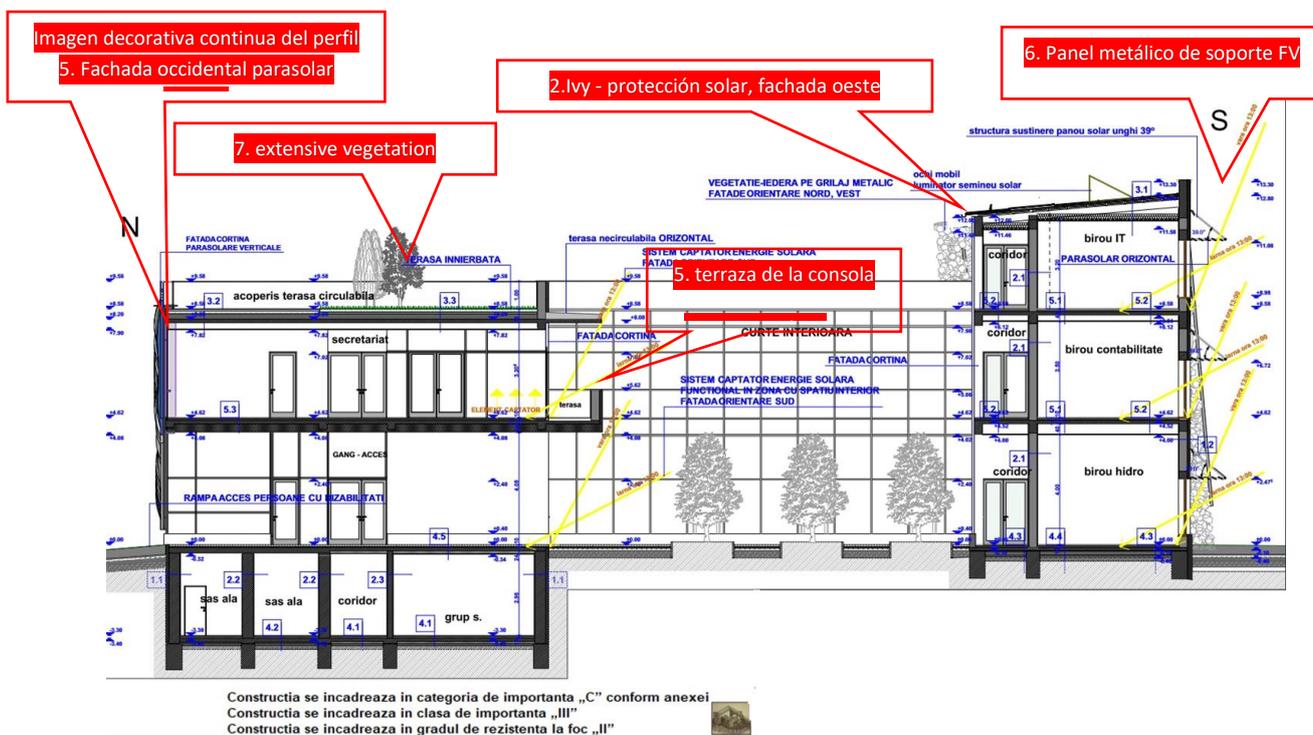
Dibujos cad de la Fase II, concepto Ditiou Nina-Cristina - sección con estructuras metálicas diseñadas para un sistema fotovoltaico; 1. Vista chimenea solar; 2. Hiedra sobre rejilla metálica- vista; 4. Vista parasoles verticales, la orientación norte no requiere parasoles, se hicieron por razones estéticas en un edificio icónico; 5. Terraza en voladizo orientación sur- visera solar horizontal; 6. Terraza en voladizo orientación sur- visera solar horizontal. Terraza en voladizo orientación sur- parasol horizontal; 6. Parasol horizontal de acero (estructura metálica que soporta los paneles fotovoltaicos) - etapa posterior; 7. Terraza vegetación extensa / vegetación alta (bienestar) - comentarios explicativos- color rojo / blanco.
